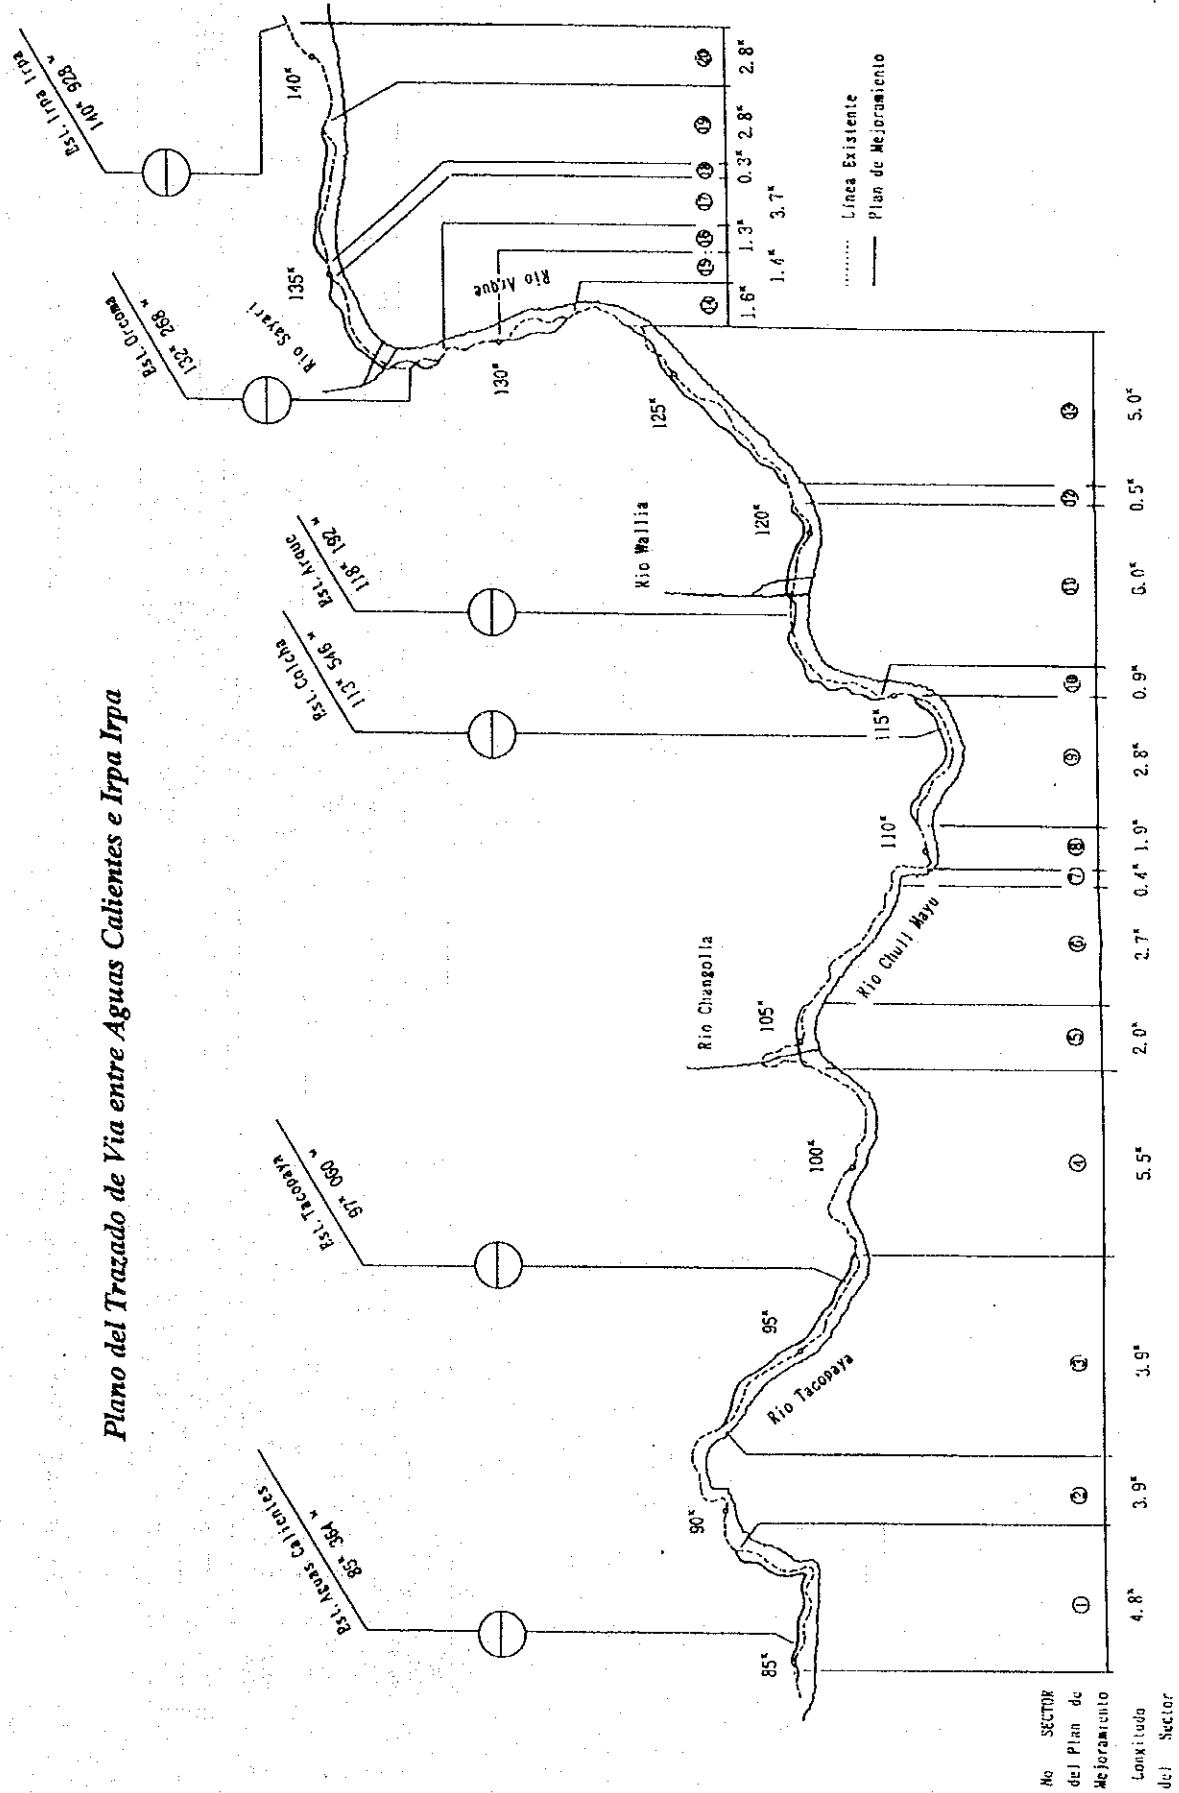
Plano del Plan de Mejoramiento de la Ferrovia entre Oruro y Cochabamba
